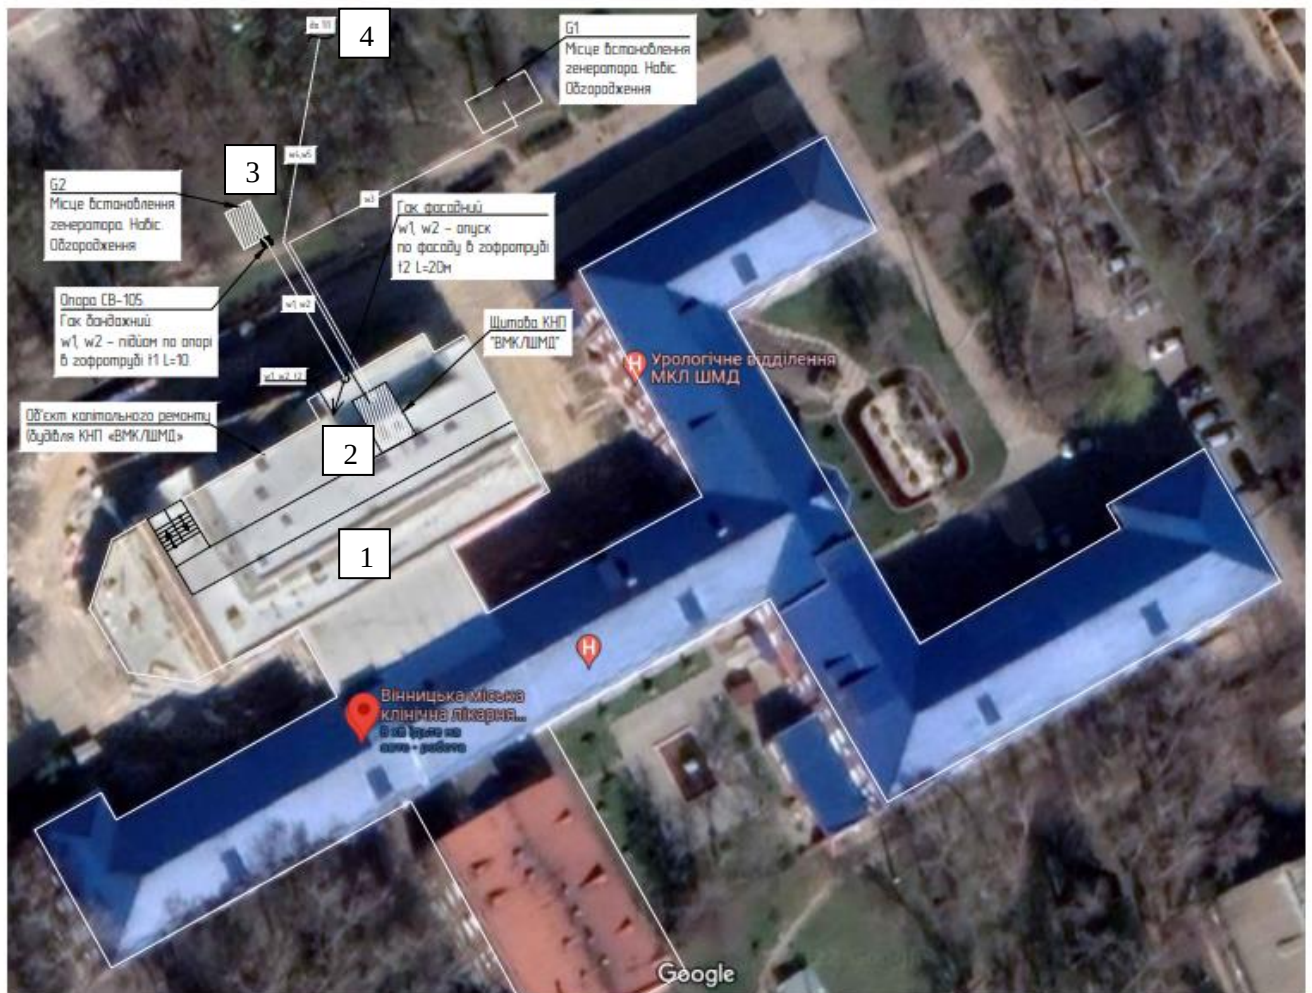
План будівлі лікарні з розташуванням генераторів
